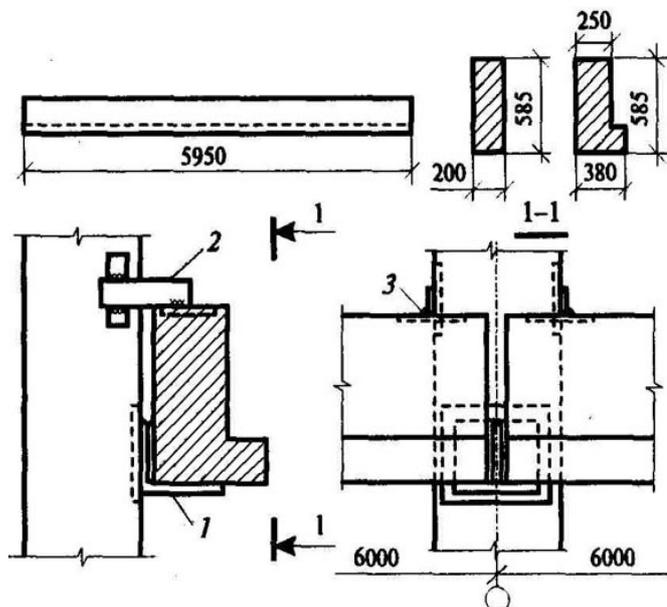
Железобетонные обвязочные балки и крепление их к колоннам:
